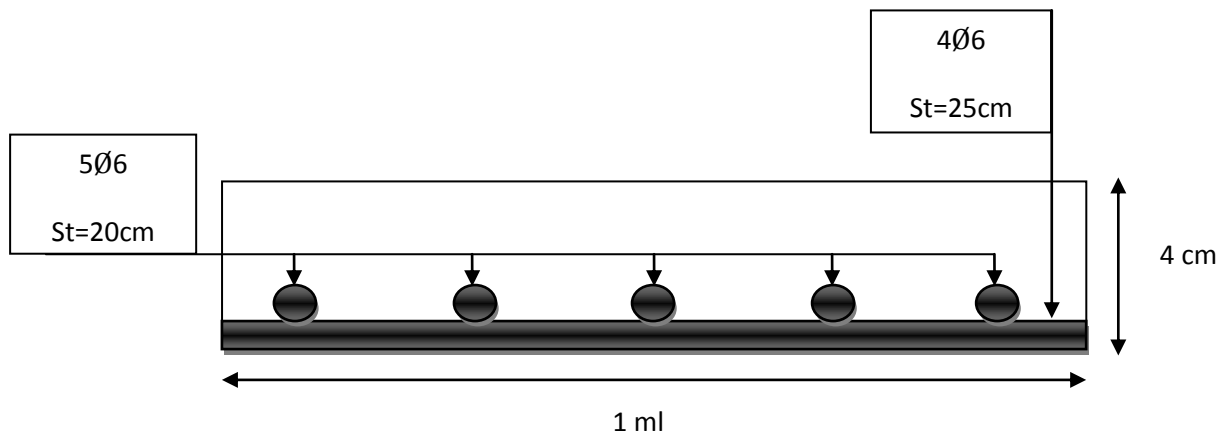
Schéma de ferrailage de la dalle de compression.
